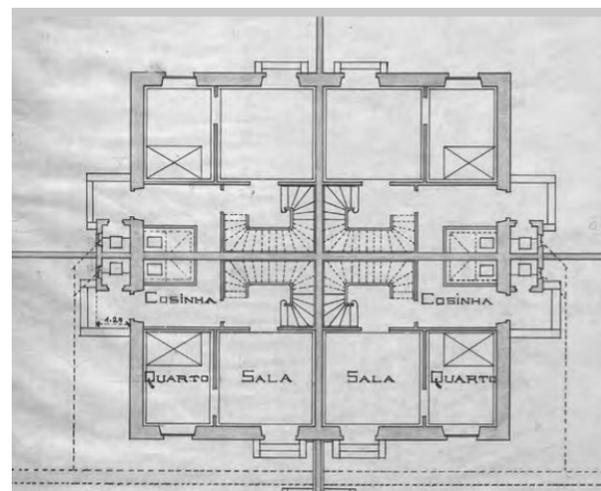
| Bairro Monte Pedral Marques da Silva, Planta térrea de um conjunto de quatro casas | Fonte: Gonçalves, 2011, p.108
